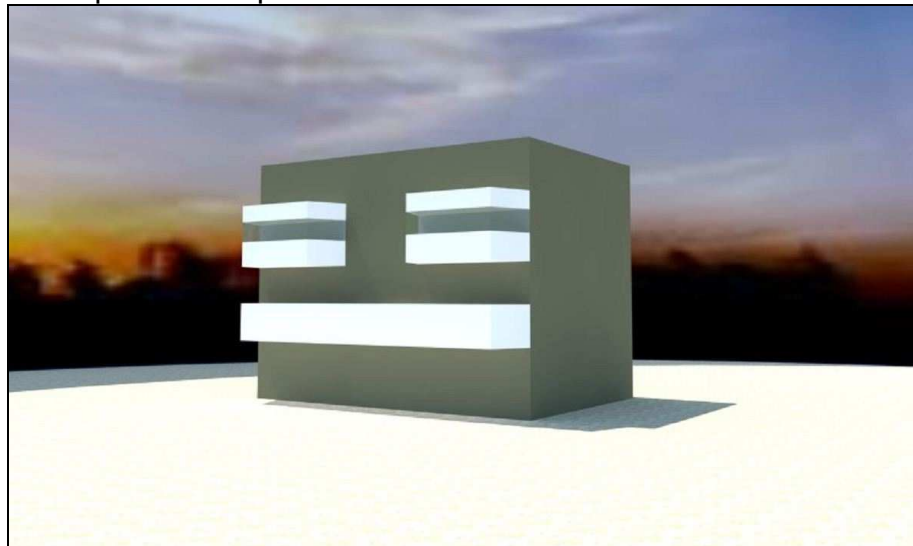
Marquises de proteção constituídas por laje simples em balanço (a), e lajes apoiadas em vigas laterais (b)
